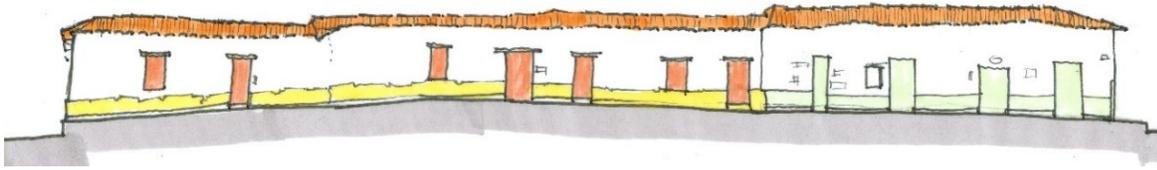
Fachada norte sobre el parque principal, en medio, caso 11.
